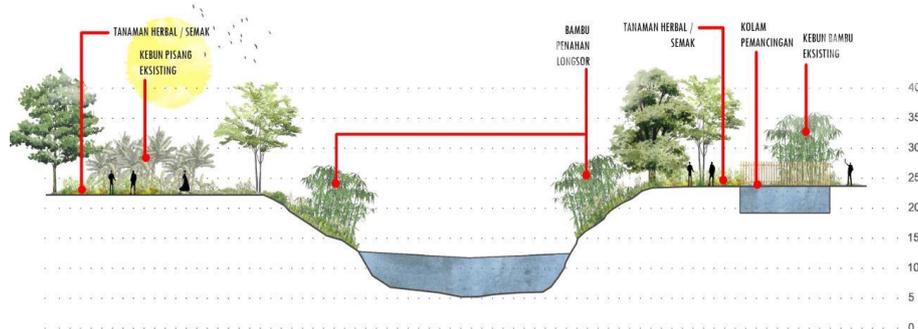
Denah Desain Lanskap Agroforestri Sempadan Sungai Condet, DAS Ciliwung Tengah
